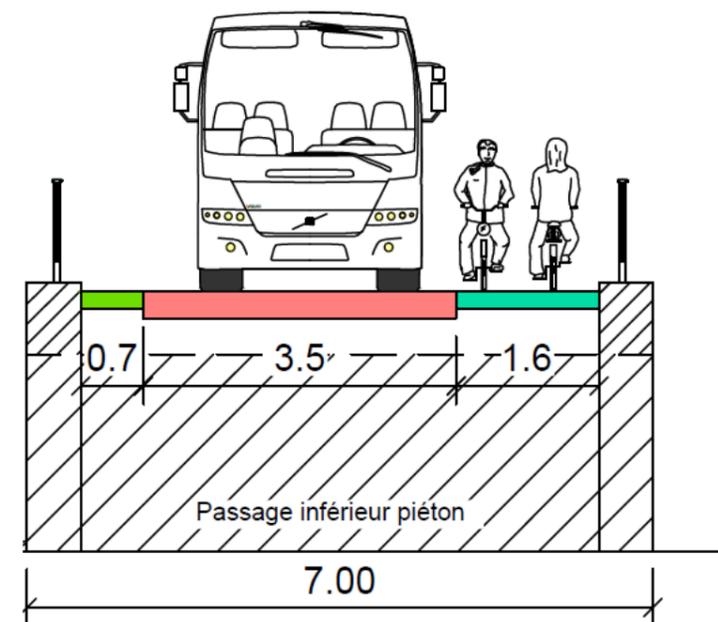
Coupe en travers projet au niveau de l'ouvrage d'art existant
